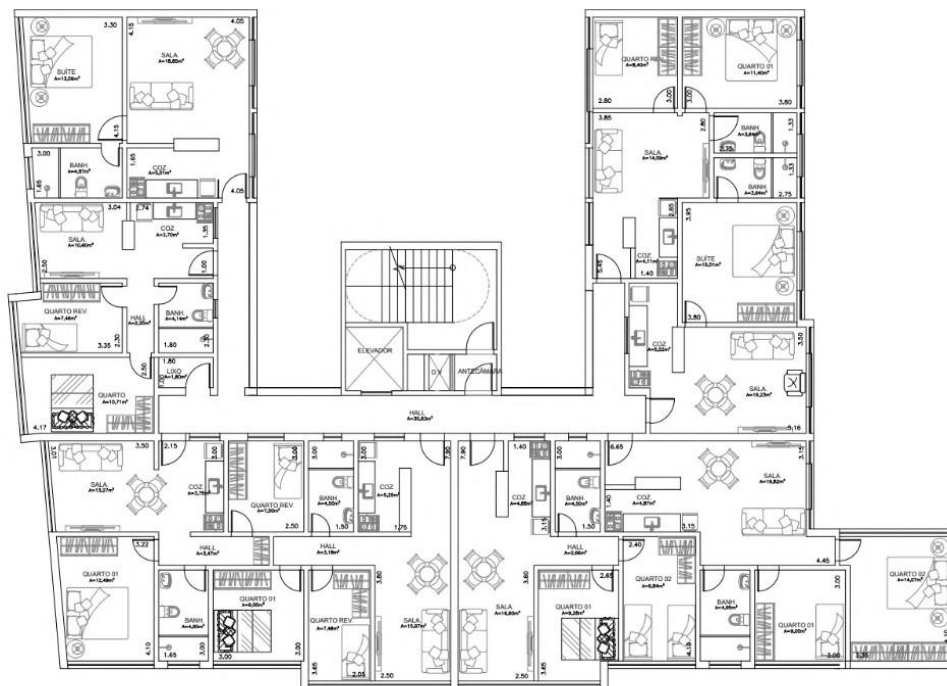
Planta - Pav. Uso Comum, Edifício ITU
